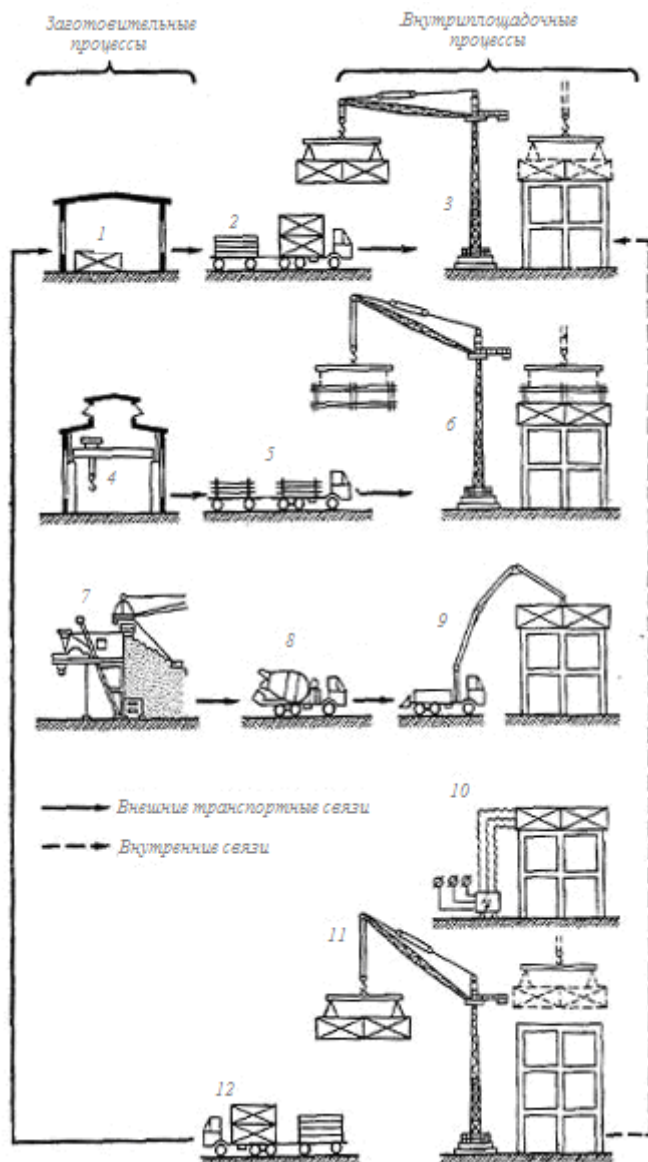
Схема комплексного процесса производства бетонных работ: 1, 2, 3 – изготовление, транспортирование, монтаж опалубки; 4, 5 – изготовление и перевозка арматурных изделий; 6 – монтаж арматуры; 7, 8, 9 – изготовление, перевозка, укладка и распределение бетонной смеси; 10 – выдерживание бетона; 11 – распалубка конструкций; 12 – транспортирование на завод подлежащей ремонту опалубки.
